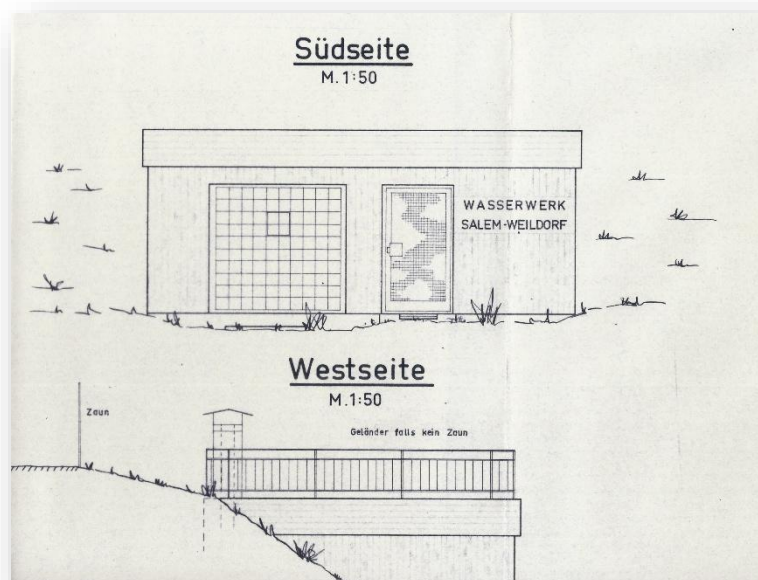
Plan für das Pumpenhaus mit einer Grundfläche von 5,00 m x 2,50 m.
